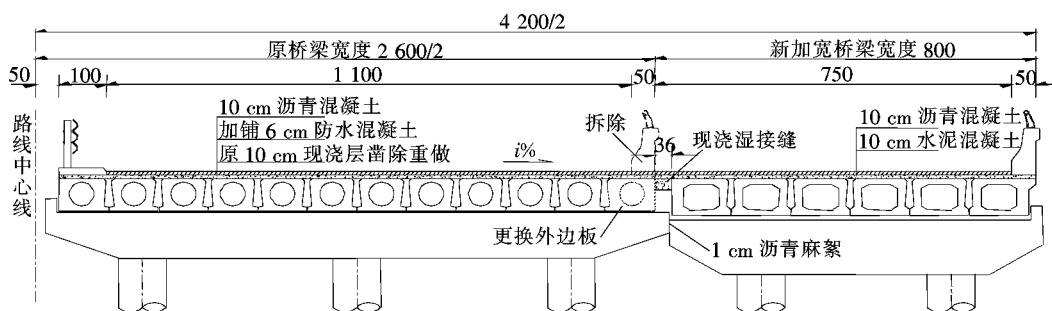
预应力混凝土空心板桥拼宽横断面示意图(单位:cm)
